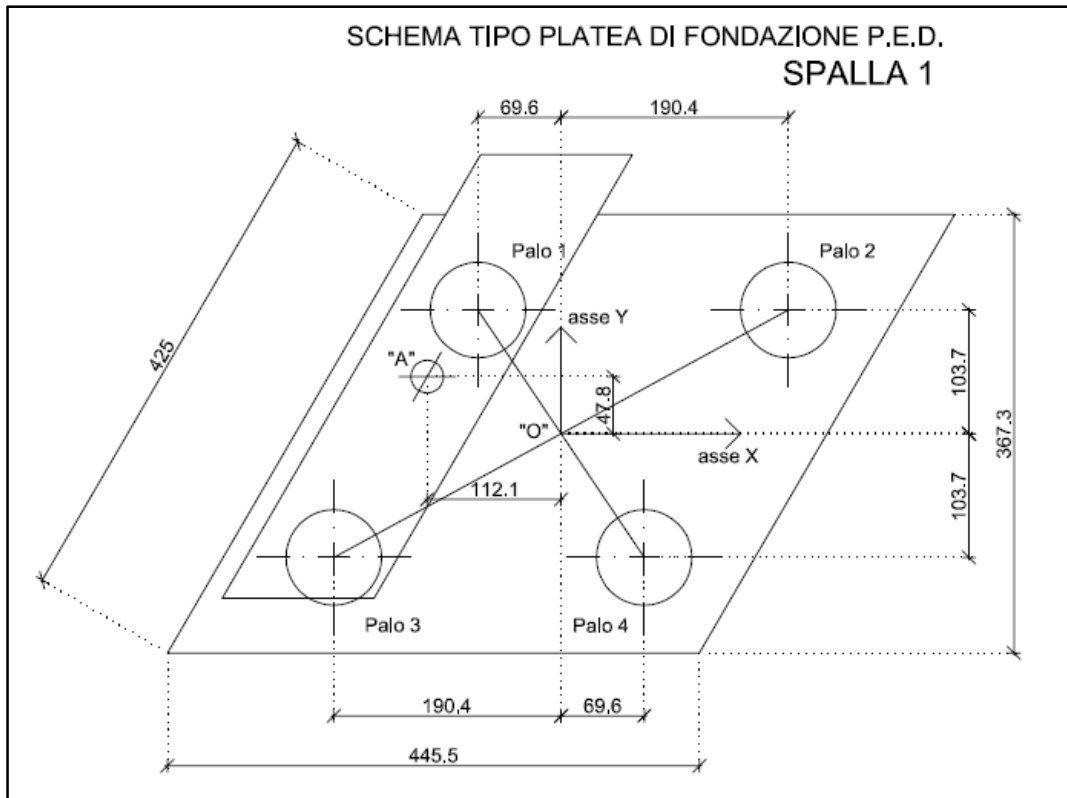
schema tipo calcolo platea/pali di fondazione P.E.D. (piedritto/spalla 1)
